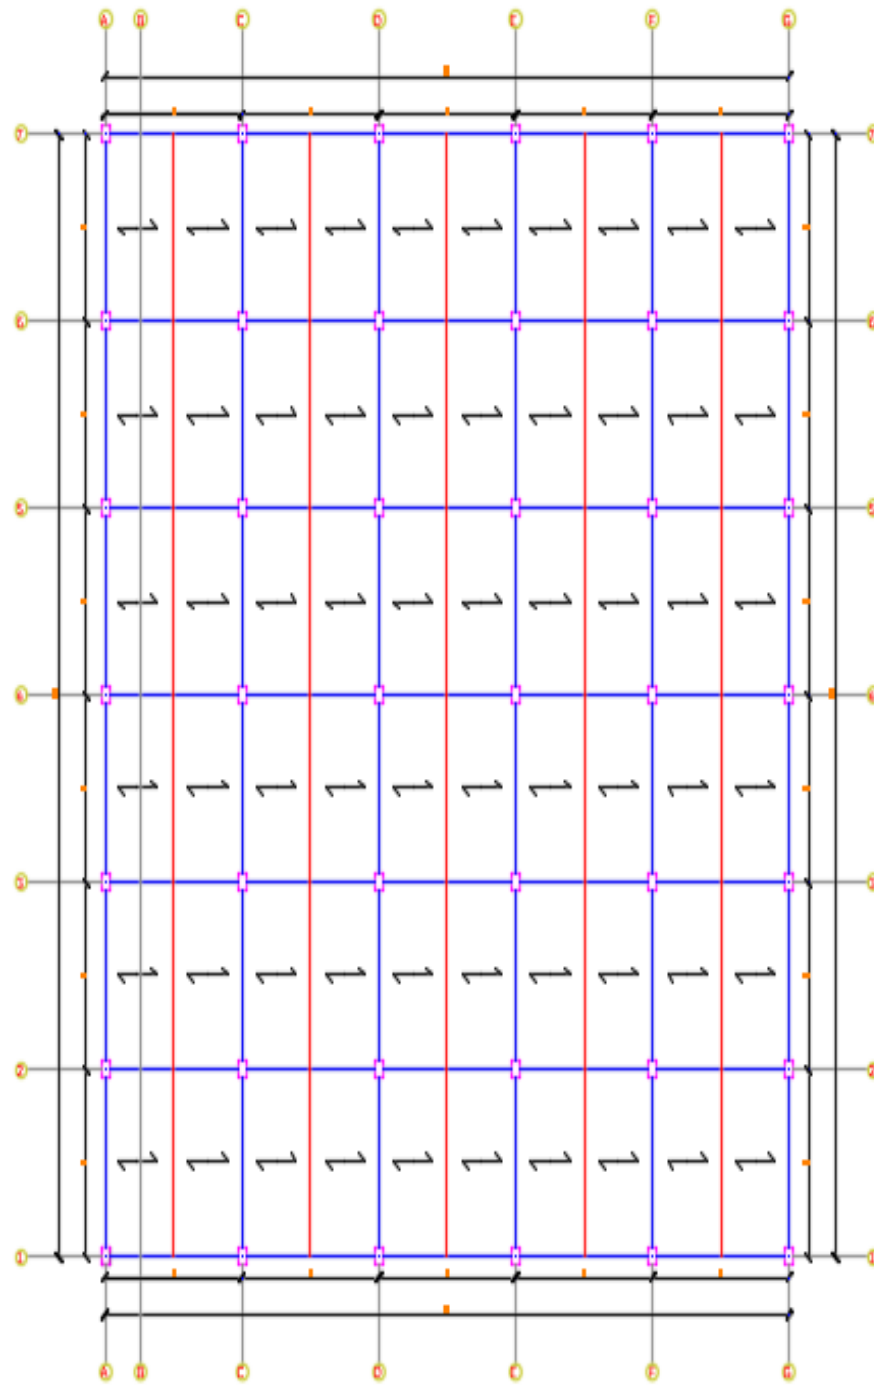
Sistema Estructural – Vista en plata de Losa.
